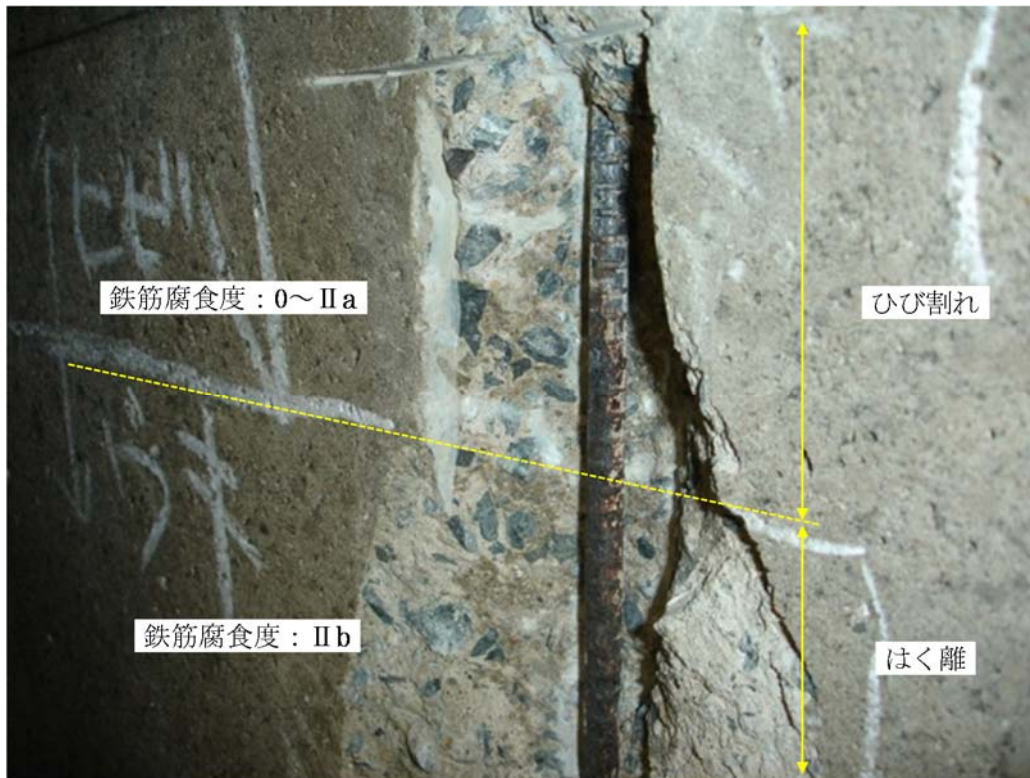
ひび割れ, はく離箇所の鉄筋腐食
